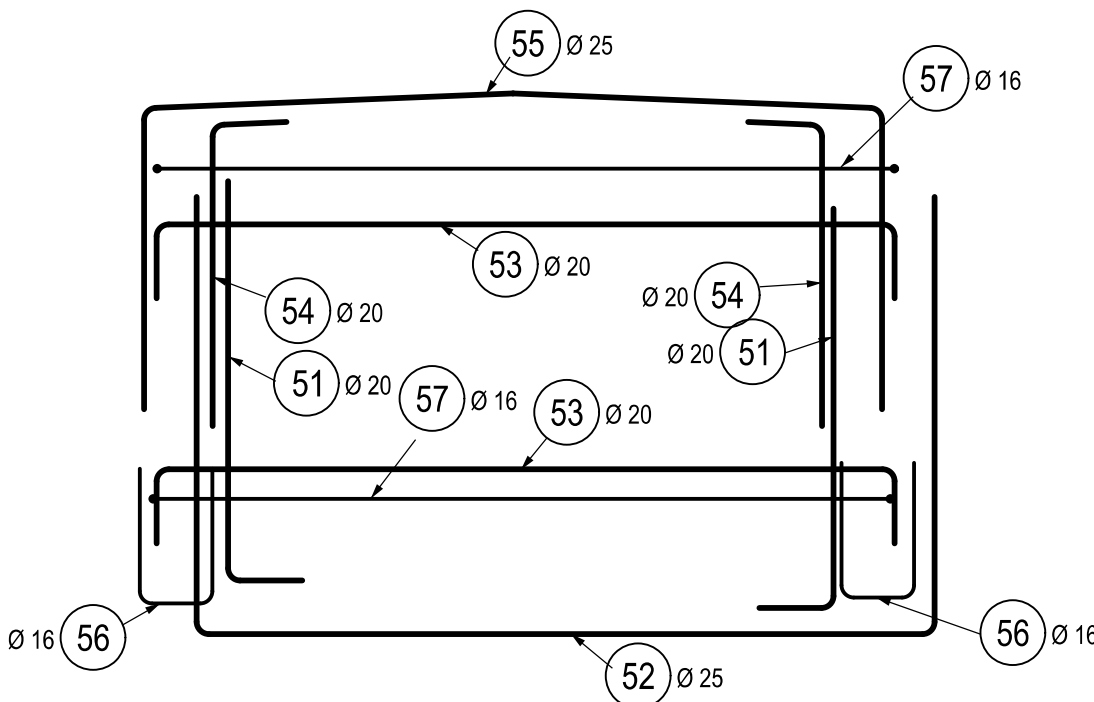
DETAIL VÝZTUŽE POD KOTVOU ZÁVĚSU, 1:25
